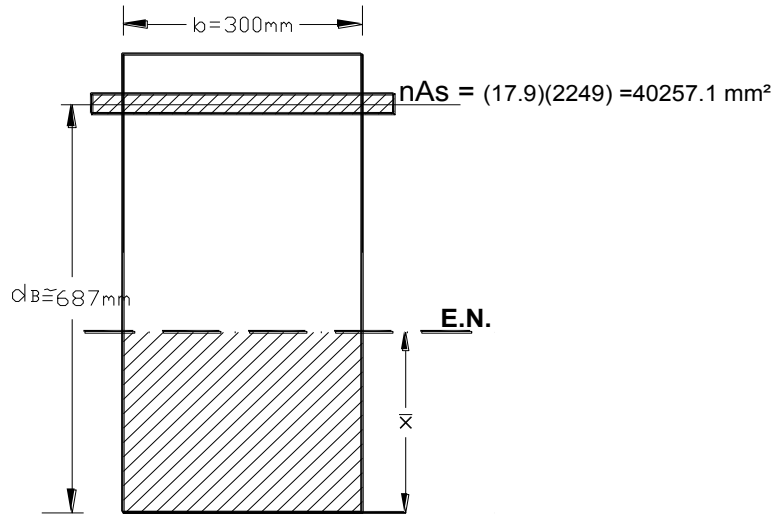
Sección transformada agrietada, para la sección extrema (B).
